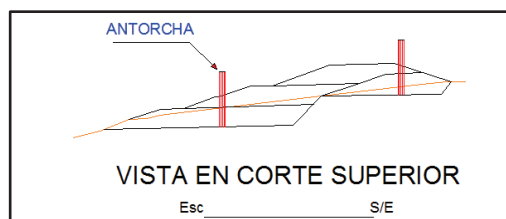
Diseño en planta del Cubeto 1 con las antorchas instaladas
